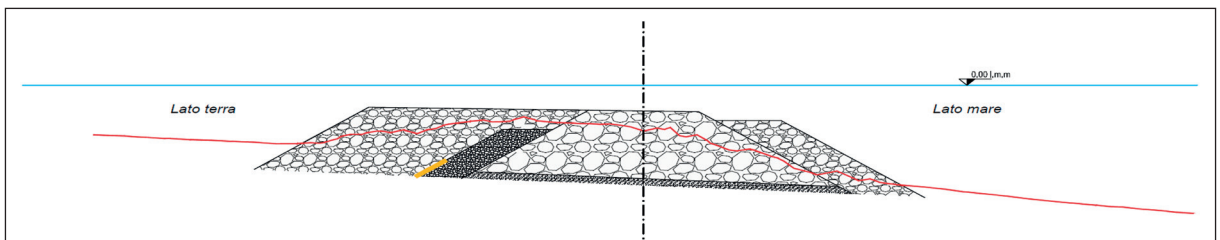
Sezione "tipo 3" della scogliera - Sovrapposizione della sezione di progetto con la sezione di rilievo n. 55.
